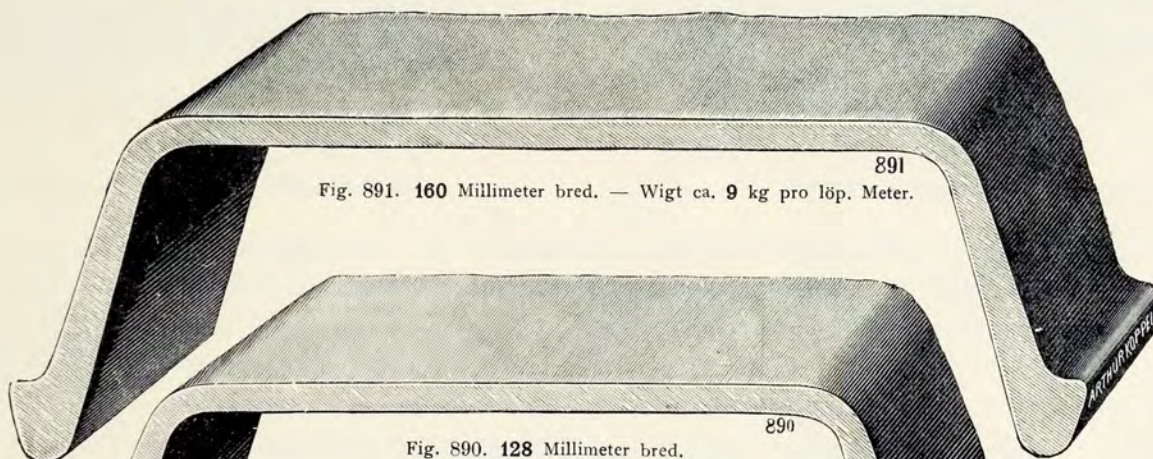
160 Millimeter bred. — Wigt ca. 9 kg pro løp. Meter.
